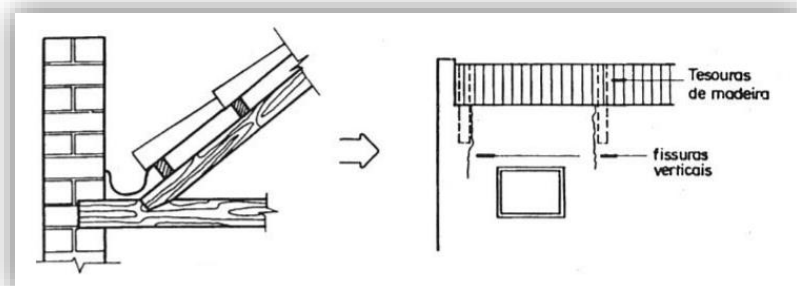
Fissuras causadas pela dilatação das tesouras de madeira no telhado.
